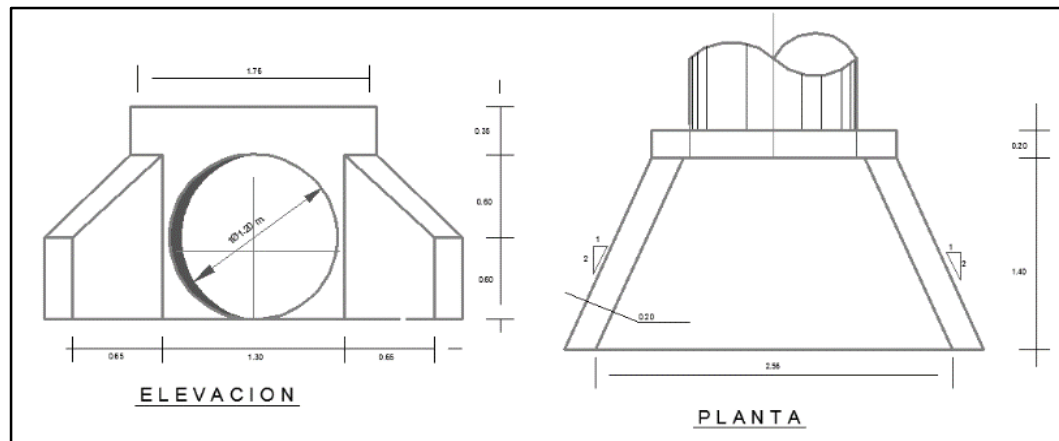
Cabezales de salida en planta y elevación – alcantarillas tipo.
